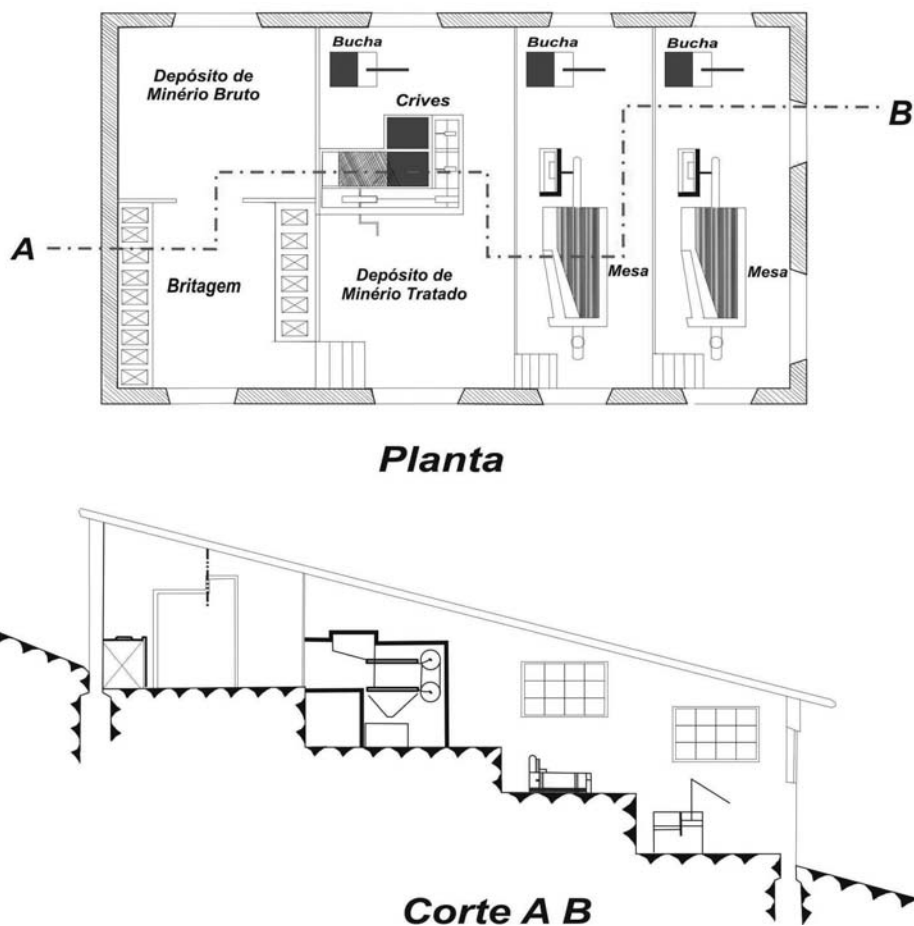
Vistas em planta e perfil de uma Lavaria-tipo (Castelhão – Vilar de Mouros).
